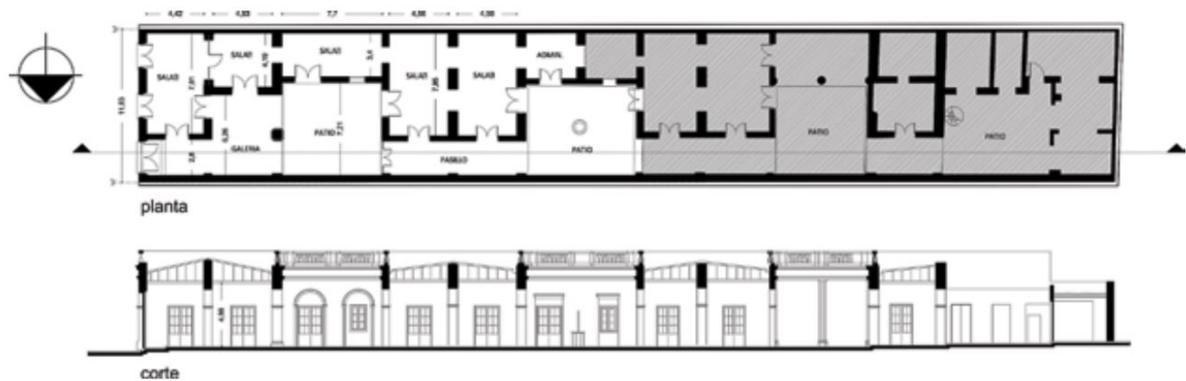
Pianta e prospetto di Casa Padilla<sup>6</sup>
